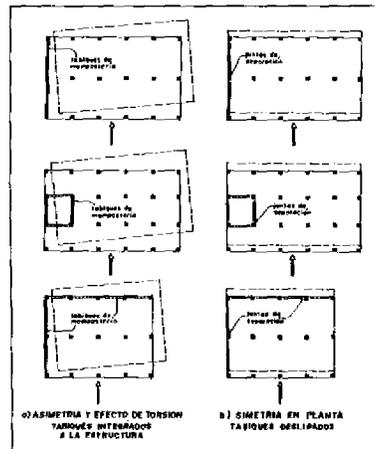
La disposición asimétrica de las paredes de mampostería inducen efectos de torsión, aún en edificios de planta simétrica - Detalles constructivos tendientes a deslizar la tabiquería del sistema resistente evitan este efecto.
